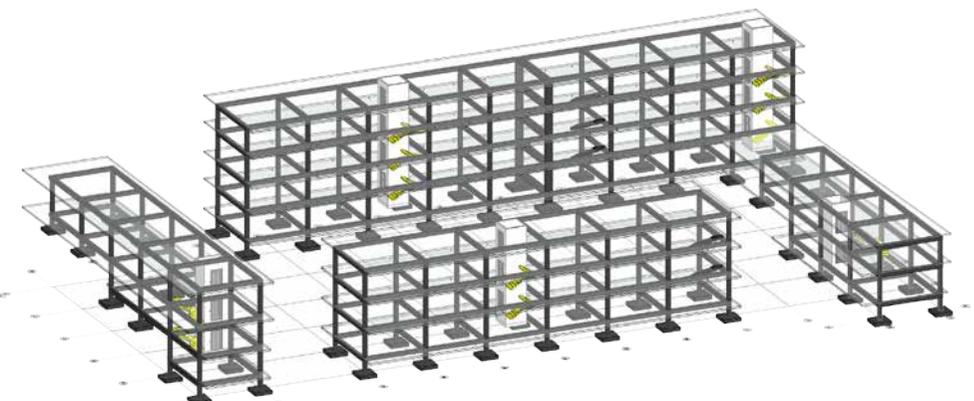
Se desarrollan las losas de hormigón armado de 0,20 cm de peralte.
